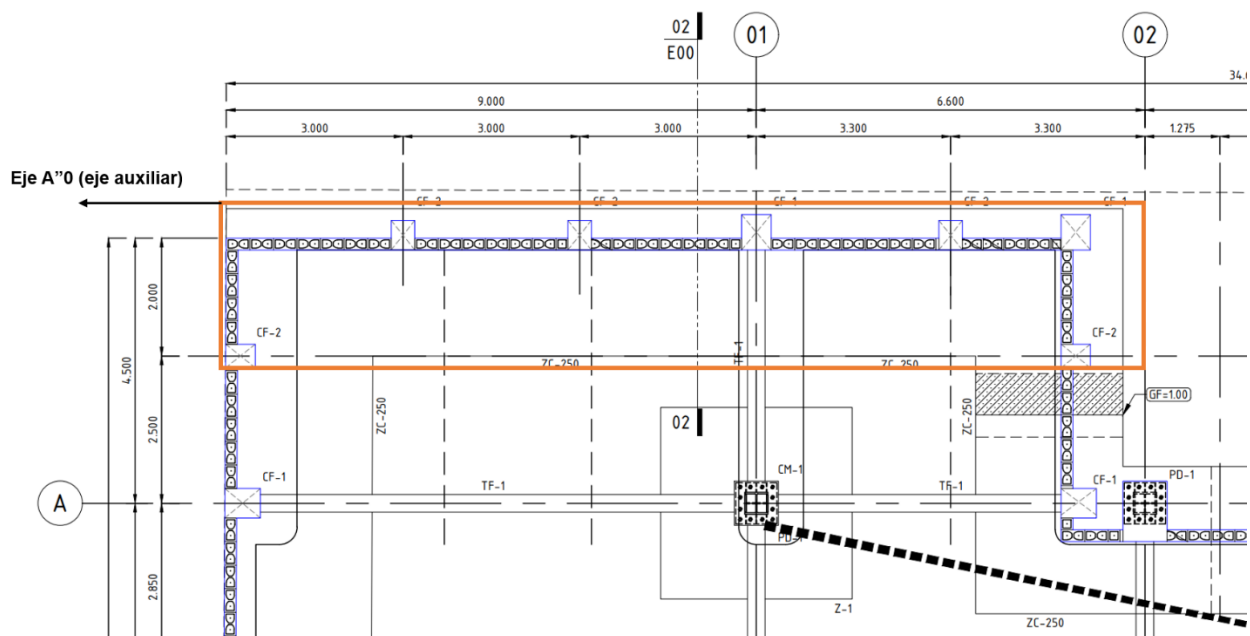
Detalle de ubicación de zapata corrida ZC-250 a colar.
